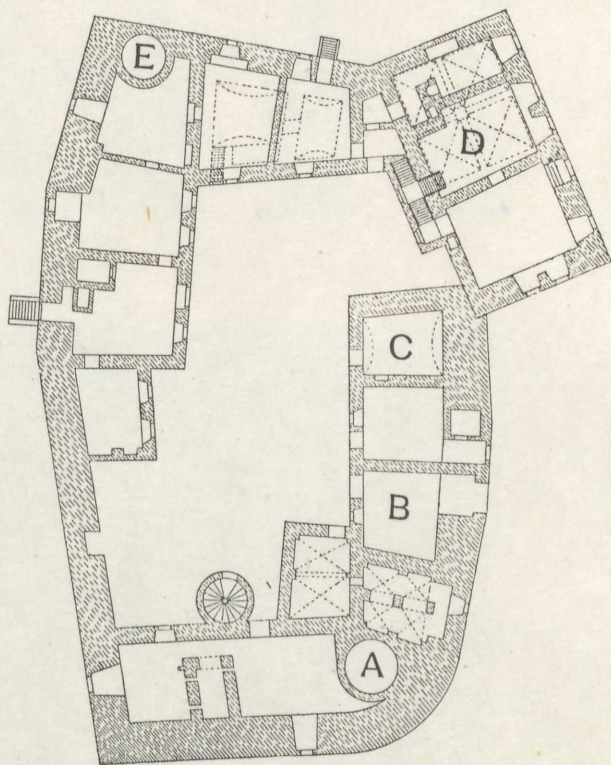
Weissen-Klempenow; Grundriss des Schlosses. 1 : 500.
